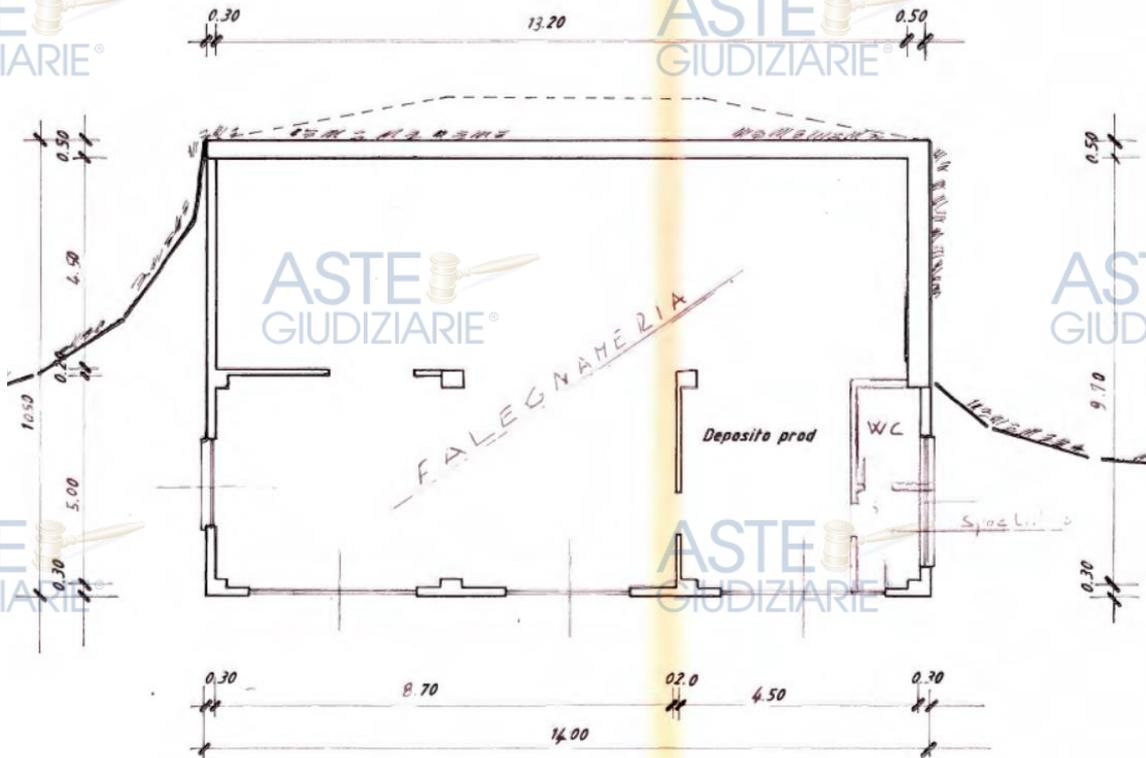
Pianta piano seminterrato e piano terra Concessione n. 02Q001 del 3 gennaio 2002
